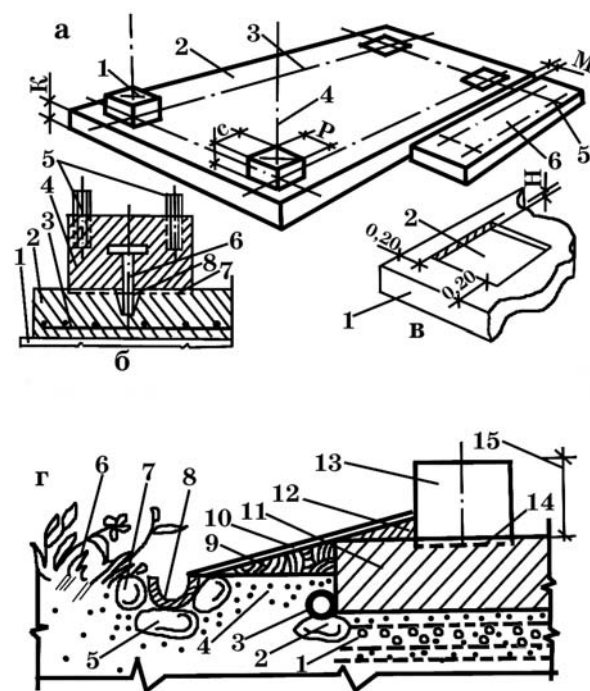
Конструкция основания садового домика со стенами из бросового материала: а—цельная железобетонная плита: 1 — кирпичный (бутовый) столбик (С=40х40 см; Р= 60х60 см); 2 — железобетонная плита; 3, 5 — разметочные оси; 4 — вертикальная ось; 6 — железобетонная плита под крыльцо (К= 22–28 см; М= 0,2–0,4 мм); б — узел стыковки столбика (кирпичный, бутовый) с железобетонной плитой основания; 1 — постелистый непучинистый грунт основания; 2 — плита; 3 — арматура; 4 — столбик; 5 — стойки ограждающей стены (металлические, деревянные); 6 — анкер (металлический); 7 — насечки на поверхности плиты; 8 — отверстие не более 10 см глубиной, сечением по анкеру, зачеканивается цементно-песчаным раствором М100; в — узел стыковки столбика (кирпичный, бутовый, деревянный из дуба, бука, осины, ели) для домика без мансардного этажа: 1 — плита основания; 2 — выдолбленное отверстие по размеру столбика с Н=0,2–0,4 мм; г — разрез цокольной части домика с отмошкой: 1 — непучинистый грунт основания; песчаная подушка по утрамбованному грунту с предварительной срезкой дернового слоя по периметру плиты основания, включая 70–80 см отмошки, слой гравия или щебня, слой песка (8 см); 2, 5 — постелистый камень; 3 — дренажная труба по периметру плиты; 4 — утрамбованный грунт основания с подсыпкой песка слоем 8 см; 6 — дерновое покрытие; 7 — упорный камень; 8 — лоток (водоотводная канава) из водостойкого материала (асбоцементные трубы, распиленные пополам и пр.); 9 — глиняный замок из плотного слоя глины; 10 — цементный слой не более 0,2–0,4 мм; 11 — плита основания; 12 — зачеканивание угла цементно-песчаным раствором М100; 13 — столбик; 14 — насечка по периметру столбика.
